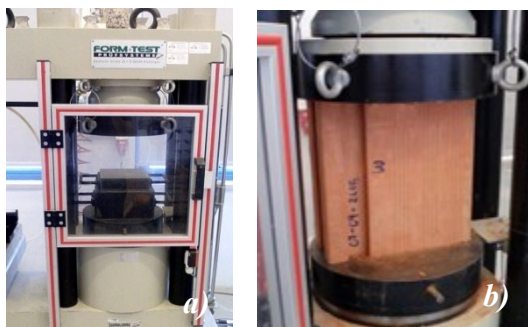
Preparação dos provetes cerâmicos para o ensaio à compressão; a)Máquina de ensaio Form Test mega 2-3000-100D; b)Colocação de provetes na máquina de ensaio.
